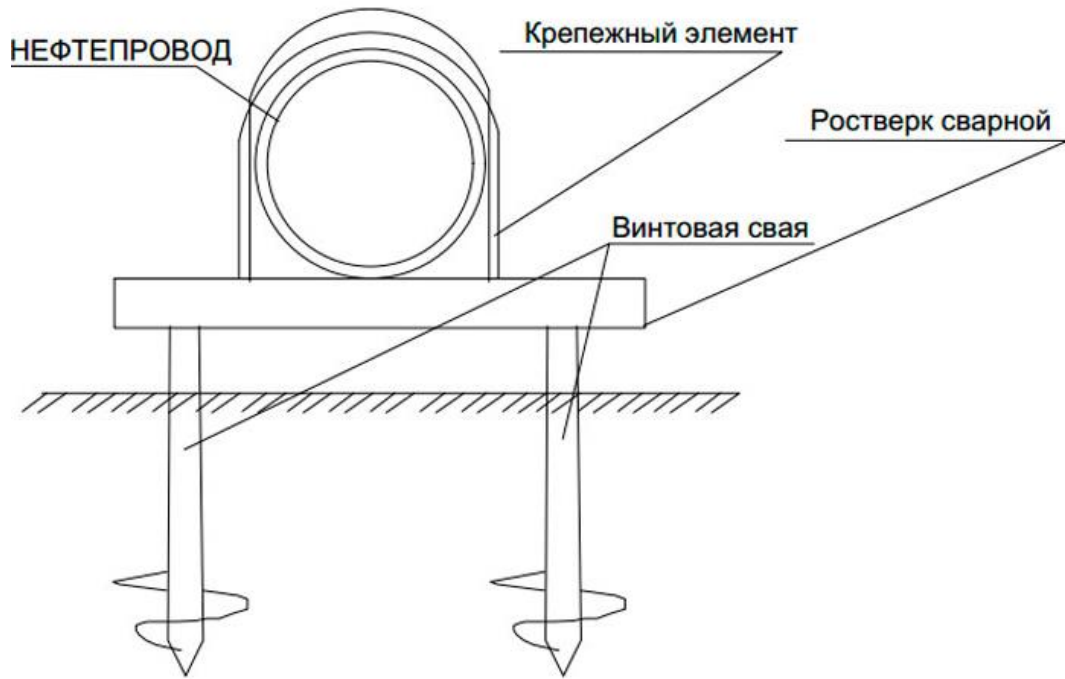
Эскиз фундамента на винтовых сваях
